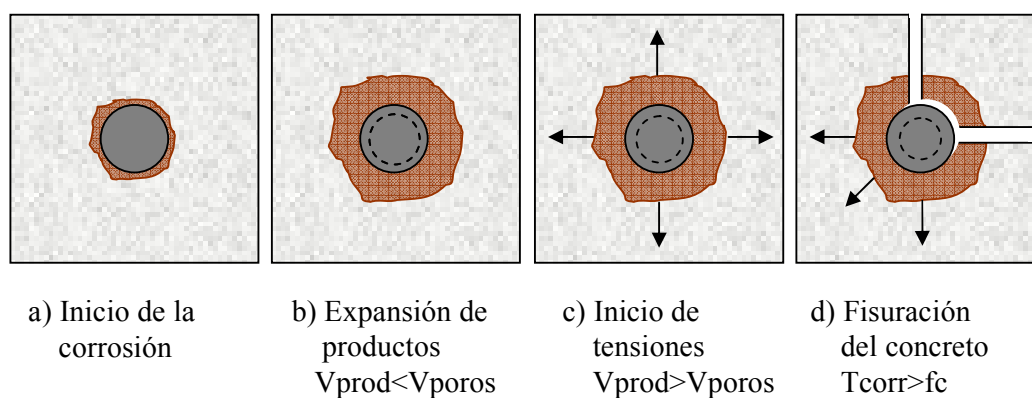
Proceso de fisuración del concreto (Weyers, R. 1998).
